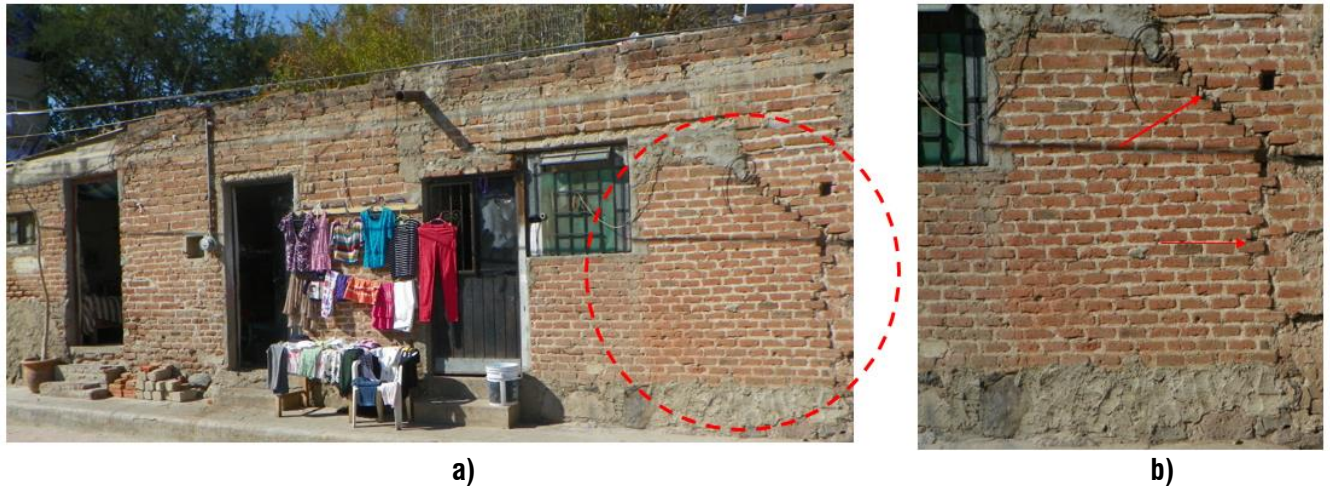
Vivienda V5 de la manzana M1; a) vista de la fachada principal y b) grieta de tipo escalonada y vertical.
